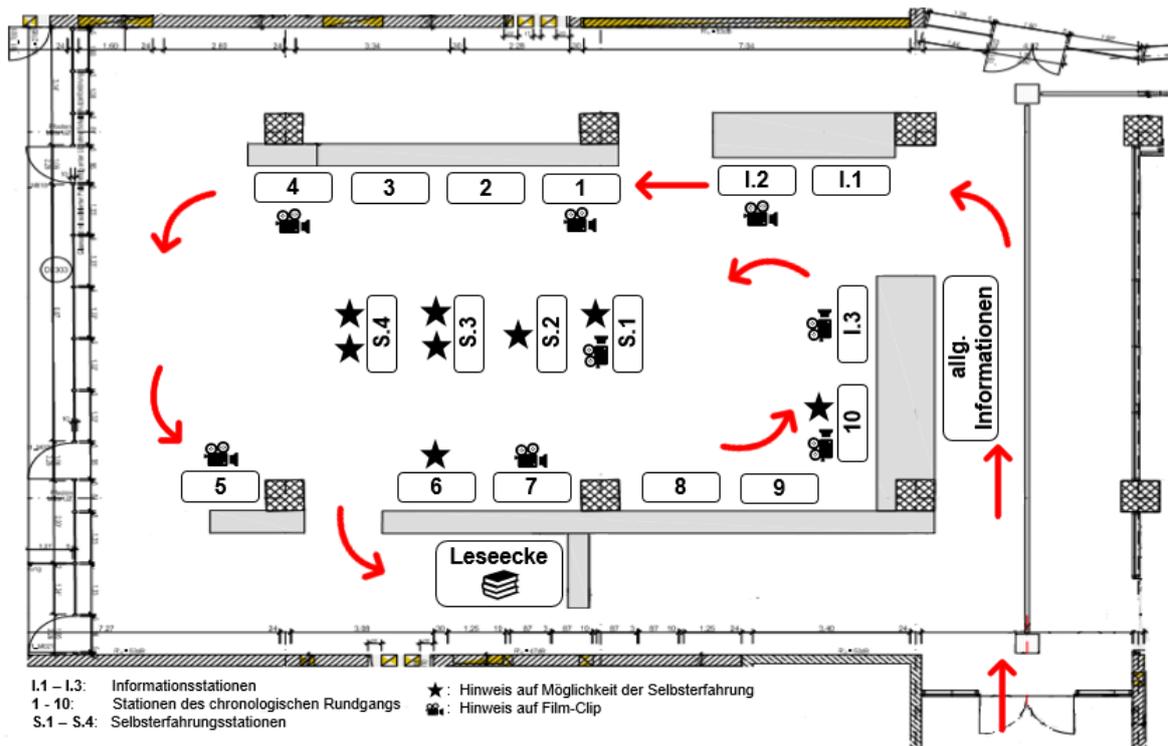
Grundriss des Ausstellungsraums im Dortmunder U mit geplanter Anordnung der Ausstellung
